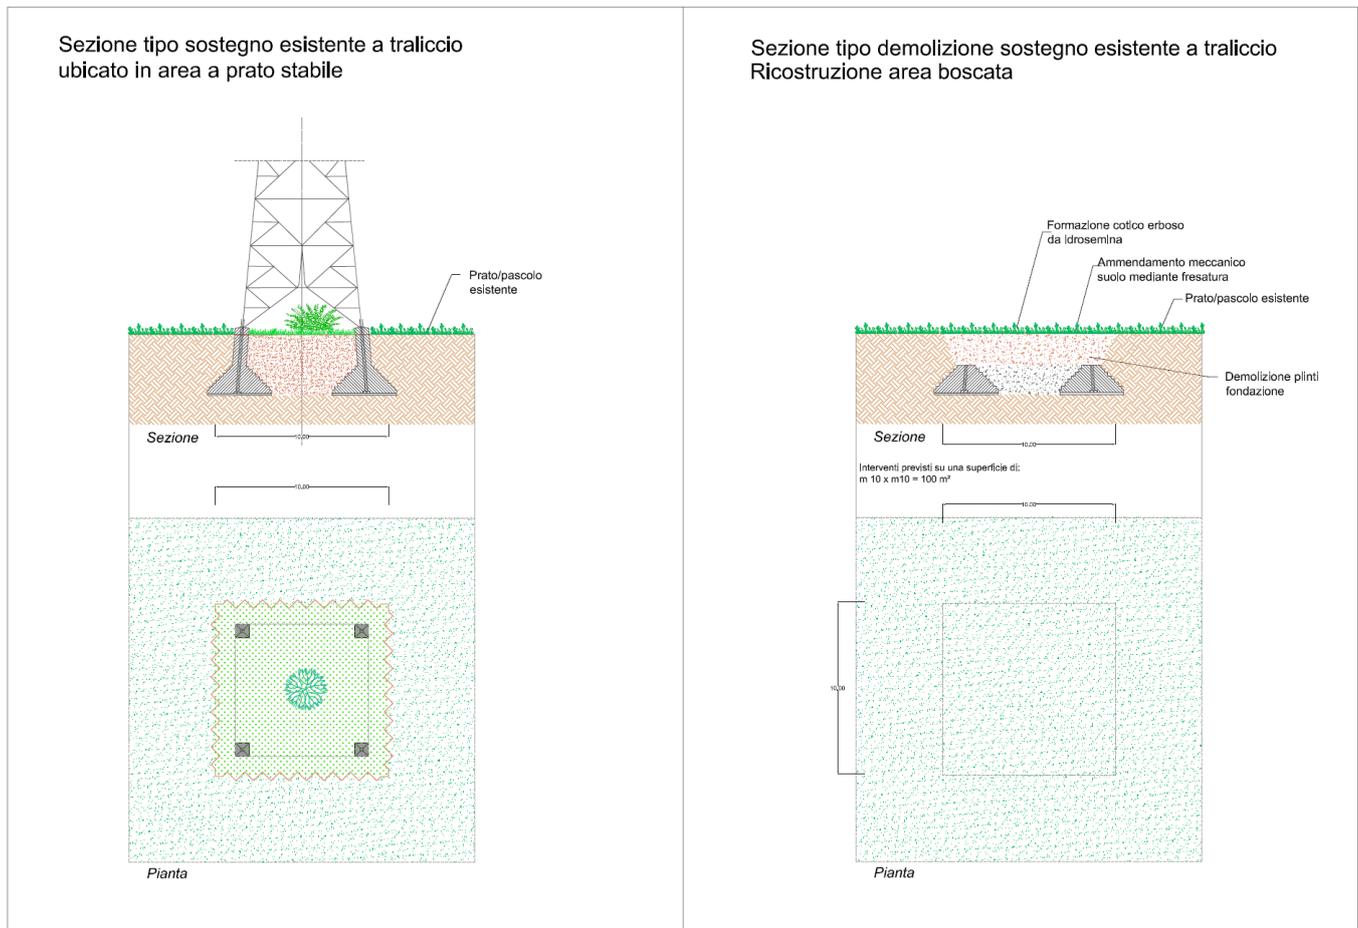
Sezione tipo e pianta Intervento Restituzione a prato stabile
